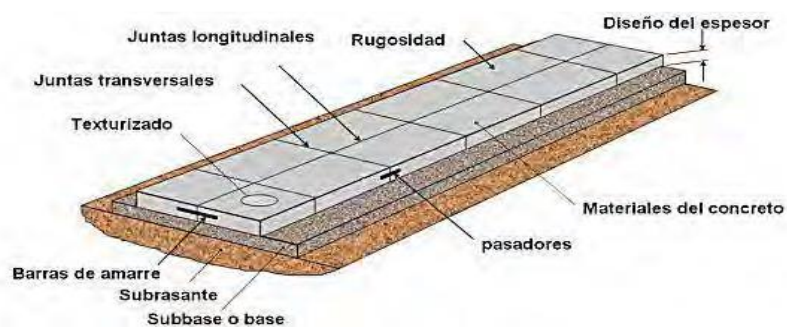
Componentes del pavimento de concreto. Fuente: Duravía, 2012.
